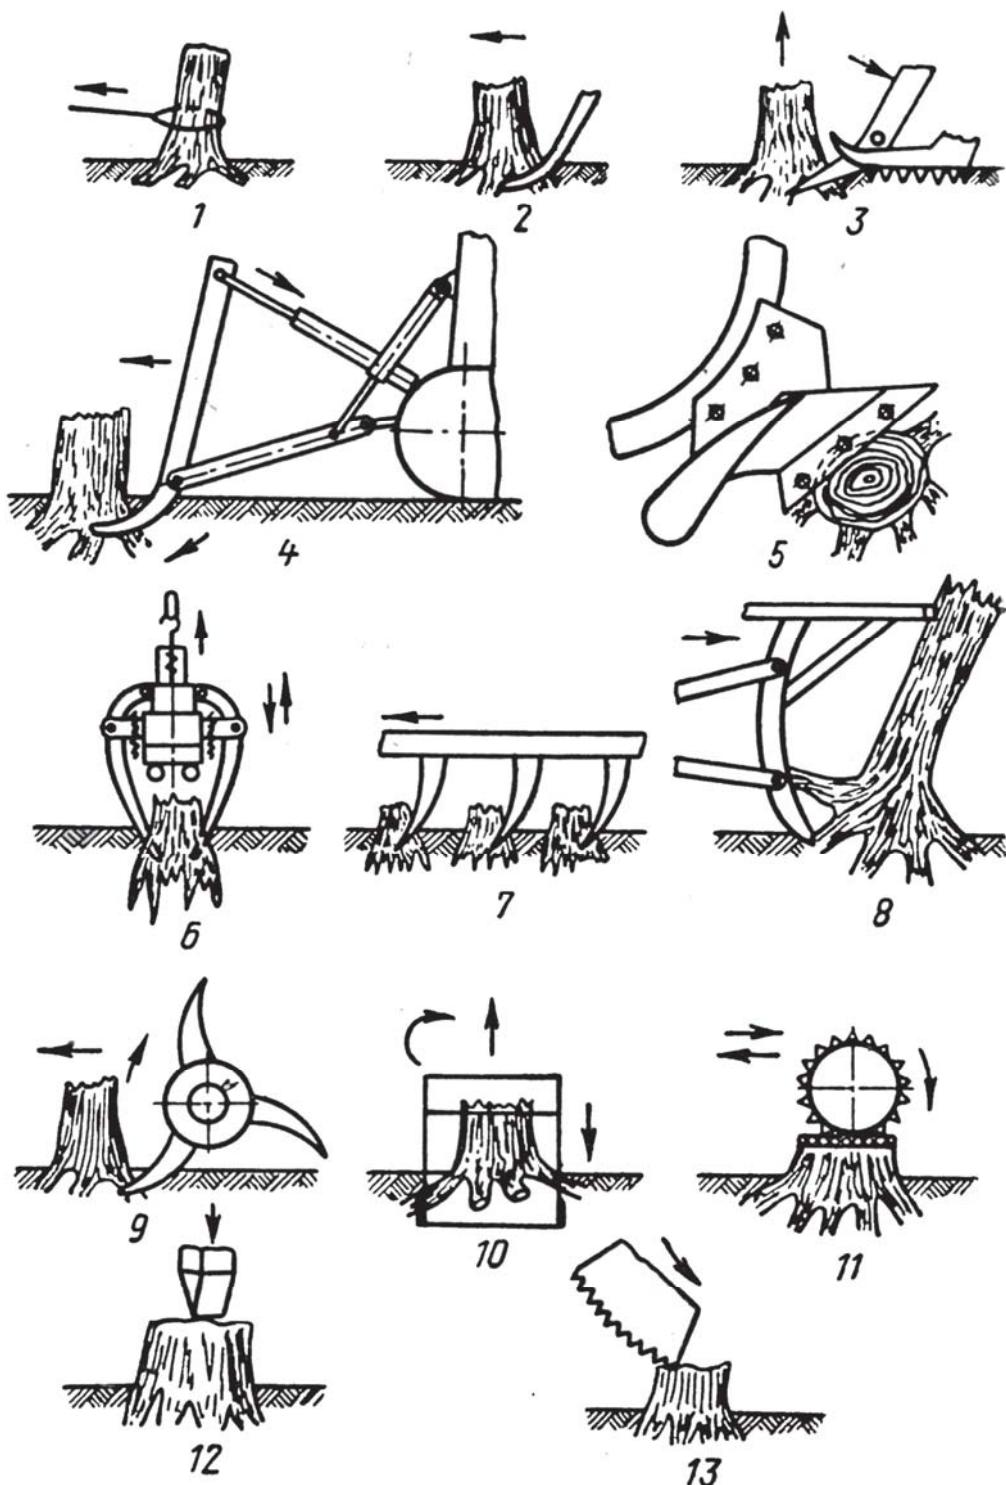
Схема машин и орудий для корчёвки пней и деревьев:
